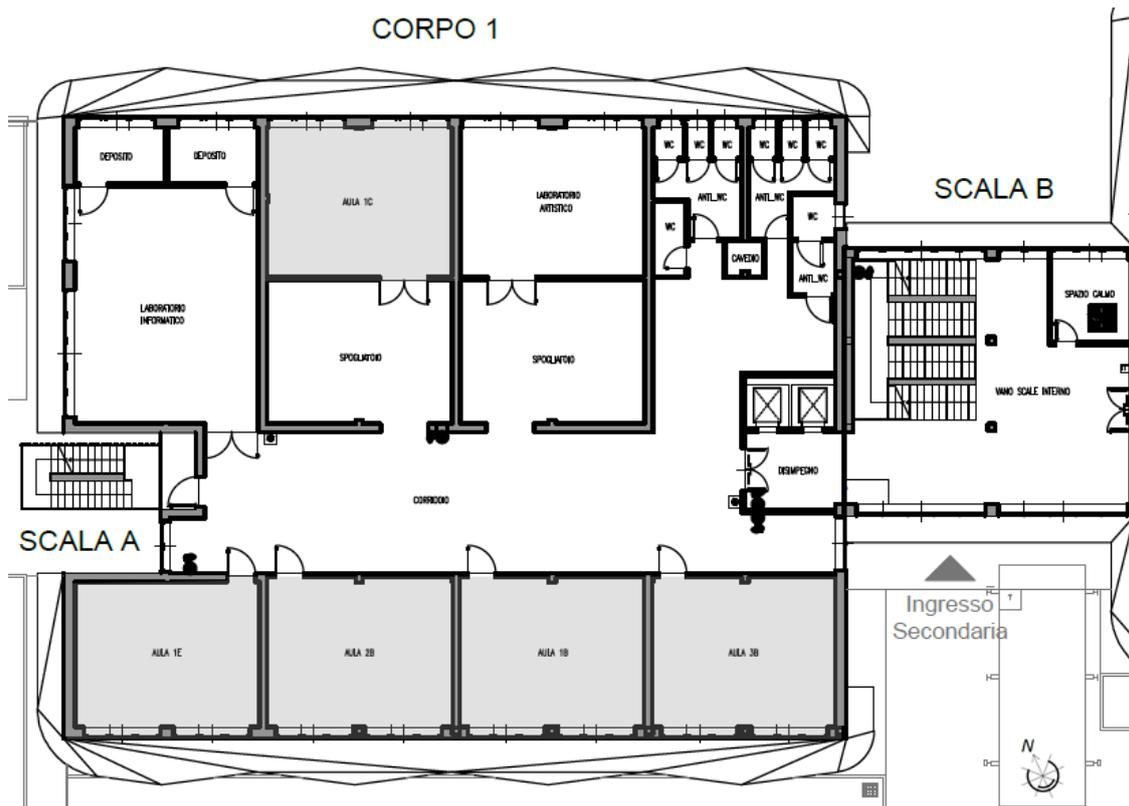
Estratto pianta primo piano scuola secondaria di I grado
